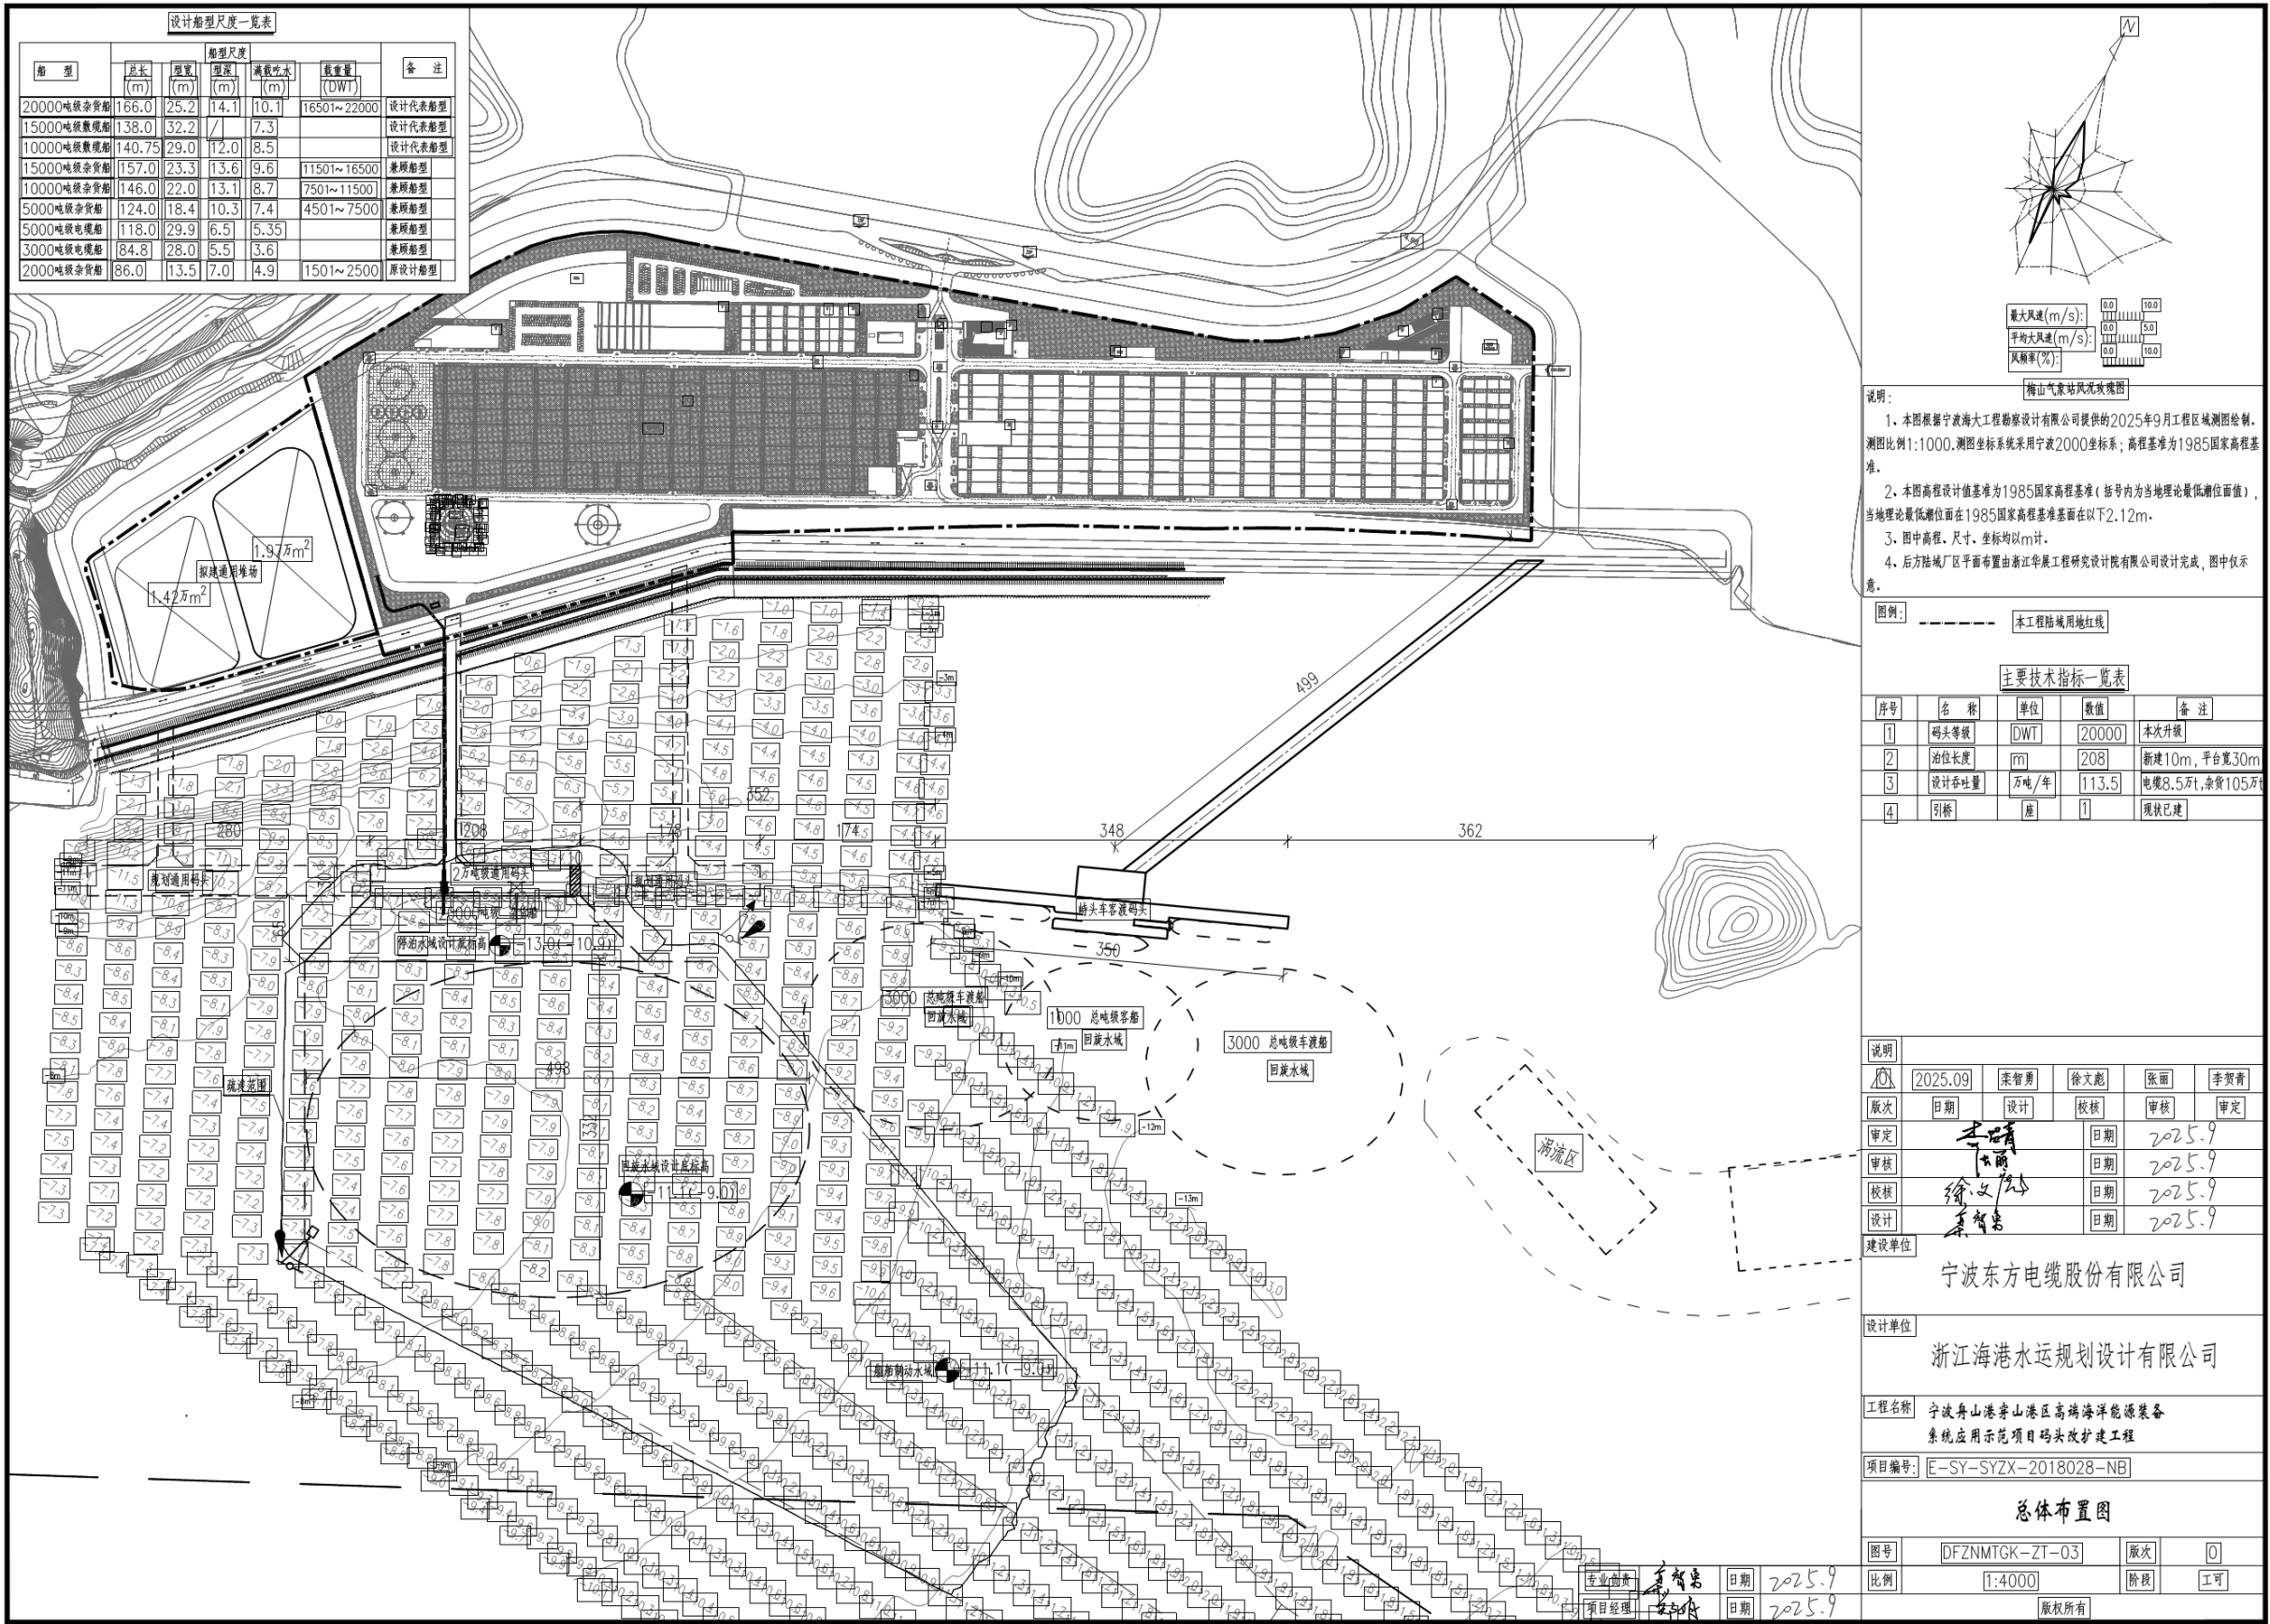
本项目码头、前沿停泊水域及回旋水域总平面布置
